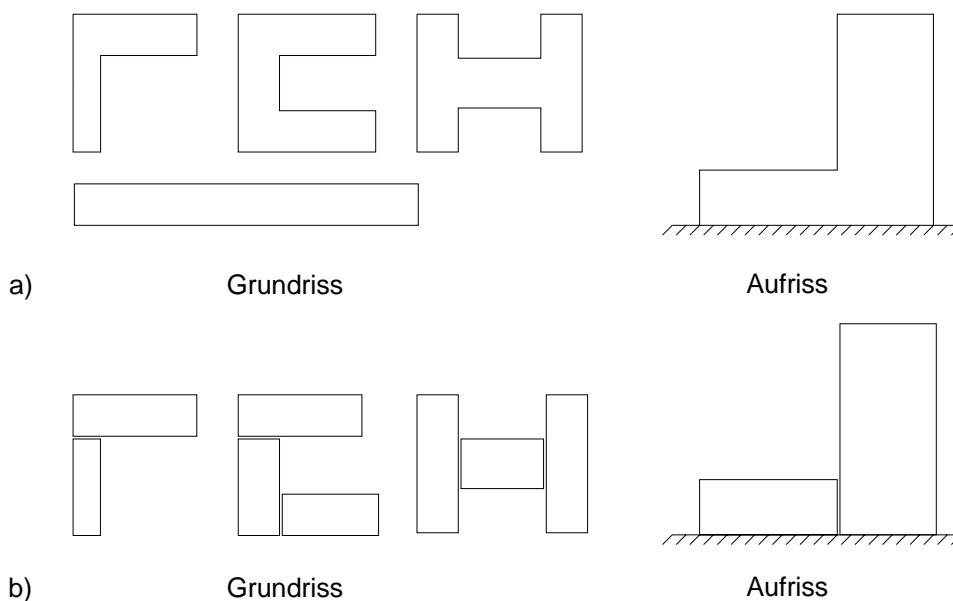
a) ungünstige Grundrissformen; b) günstige Grundrissformen
